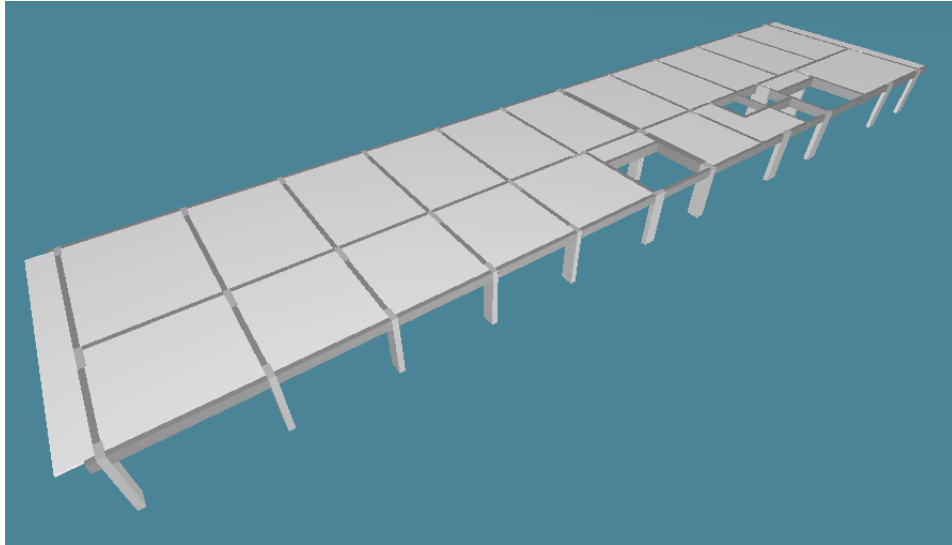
Modelo 3D do pavimento tipo lançado no TQS. (Fonte: Autor, 2023)
